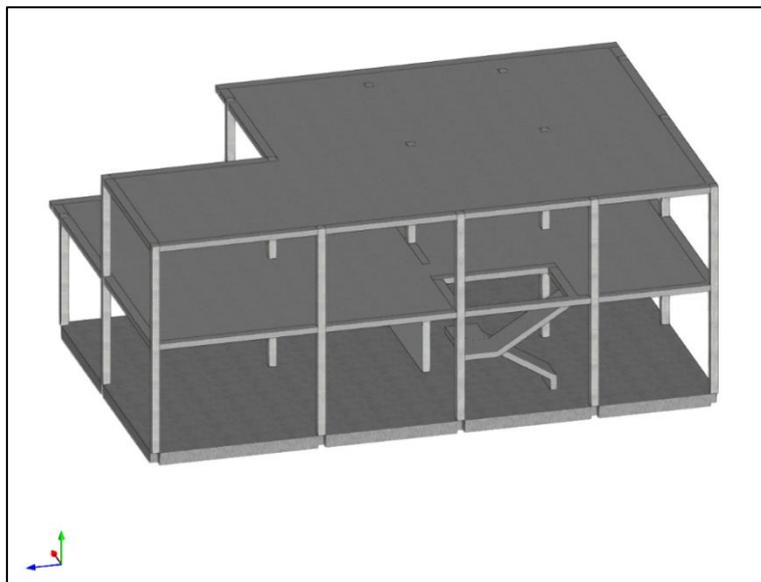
Recorte de pantalla, Vista 3D núcleo de escaleras de Cypecad
